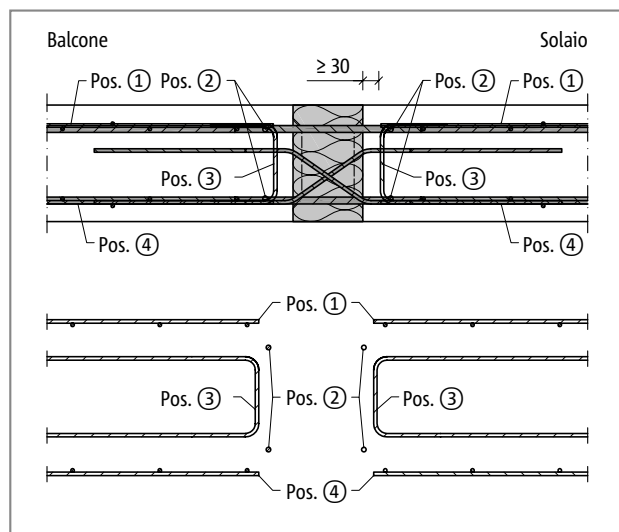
Schöck Isokorb® tipo DXT: armatura in opera
